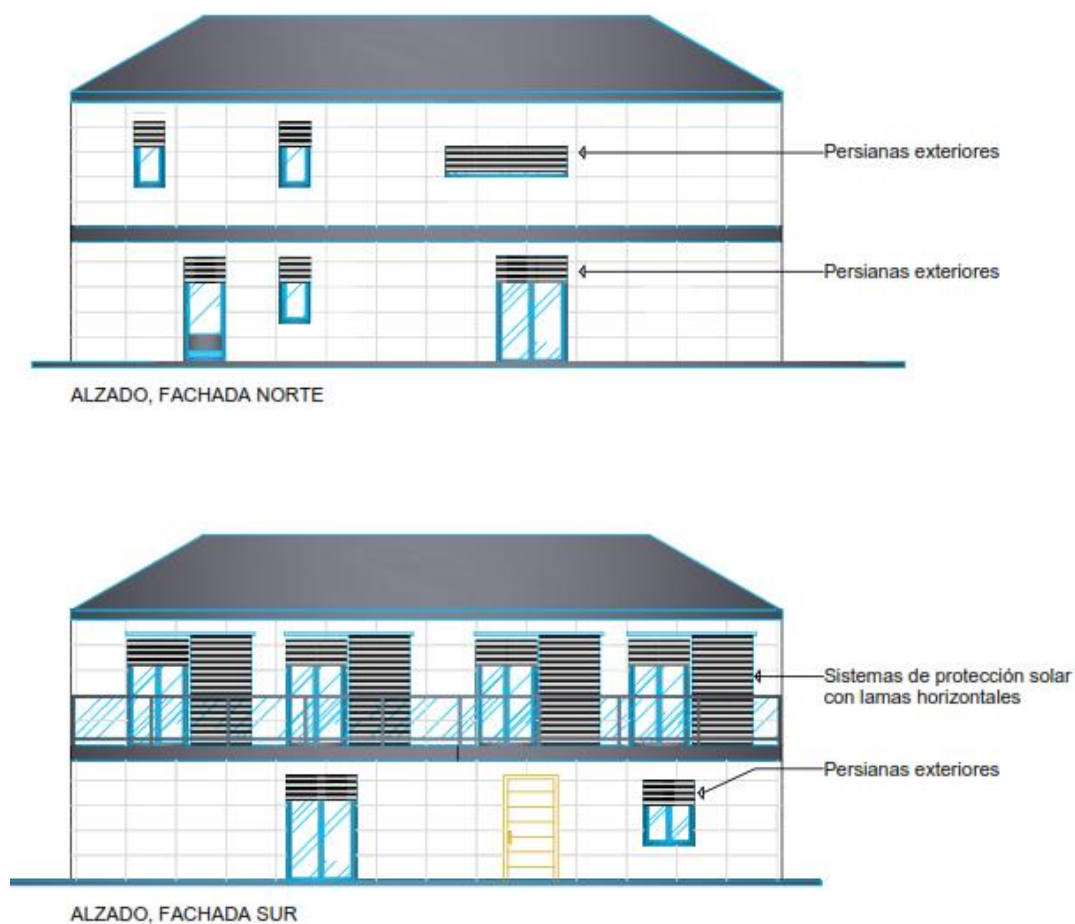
Persianas exteriores en fachada norte y sur, y sistemas de protección solar con lamas horizontales en fachada sur.
